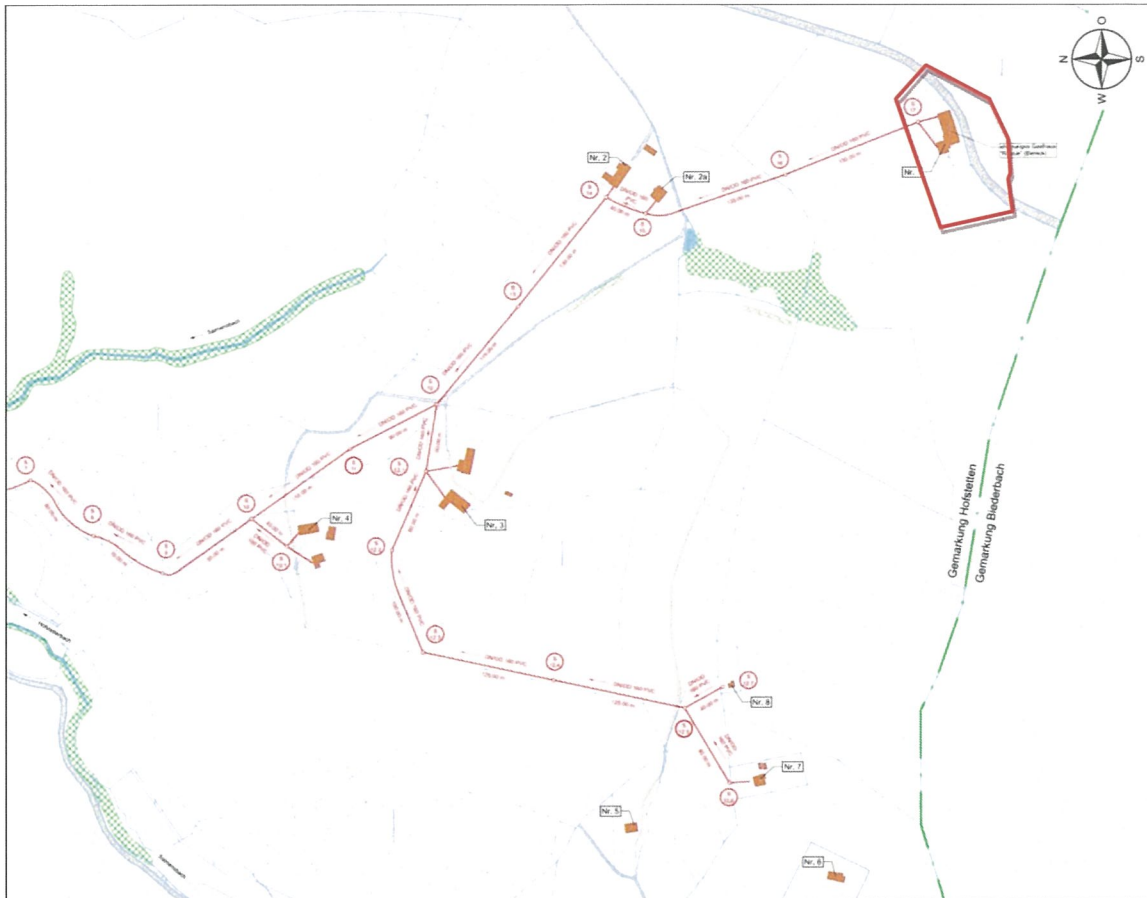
Lageplan der Abwasserbeseitigung Munde (Stand: 14.11.2016) mit schematischer Darstellung des Plangebiets
